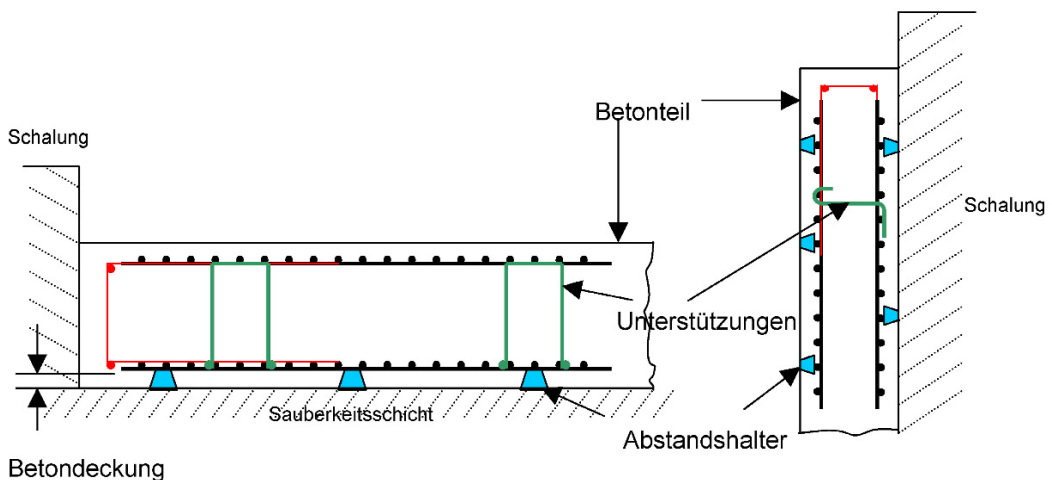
Abstandshalter (blau) und Unterstützungen (grün) zur Sicherung der Betondeckung und der Geflechtmaße
